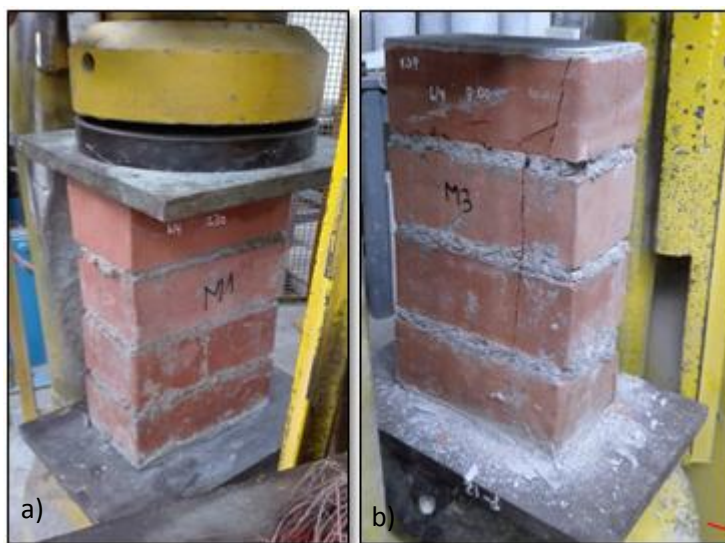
Colocado del espécimen en la máquina de compresión(a); espécimen después de la compresión de pila de albañilería (b)
